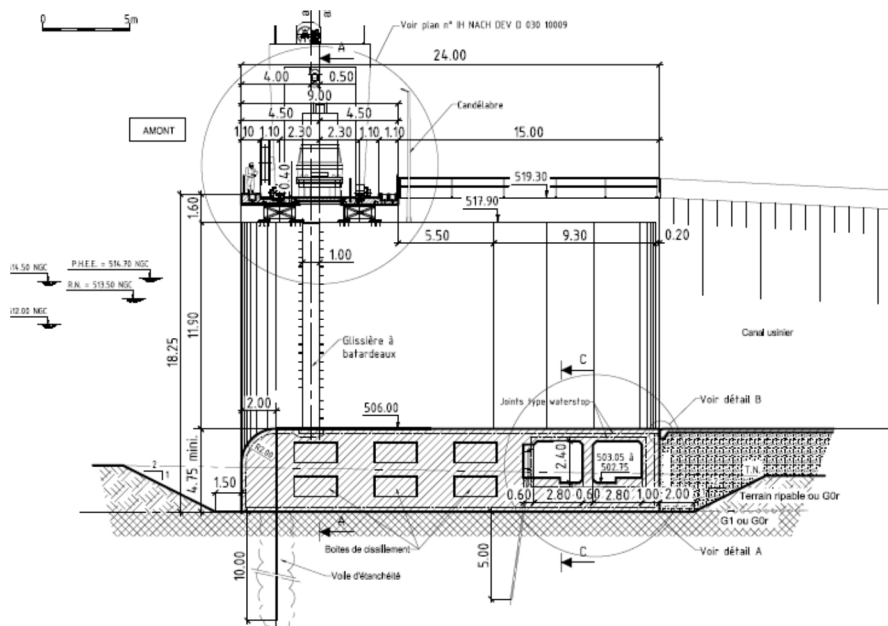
Coupe amont-aval sur la prise d'eau du canal usinier
